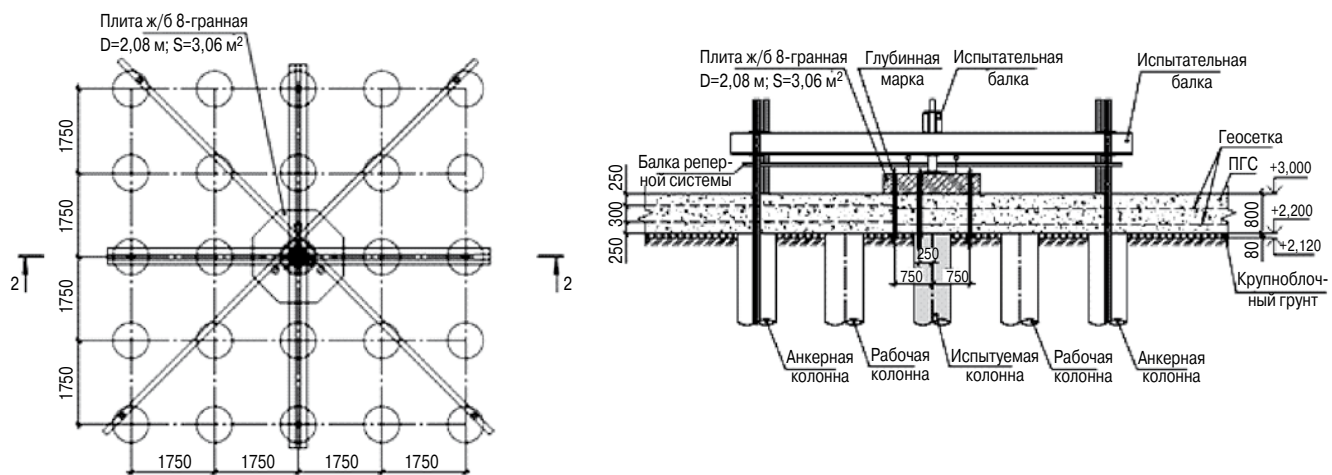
Схема испытания укрепленного грунта штампом для схем укрепления № 2–4
